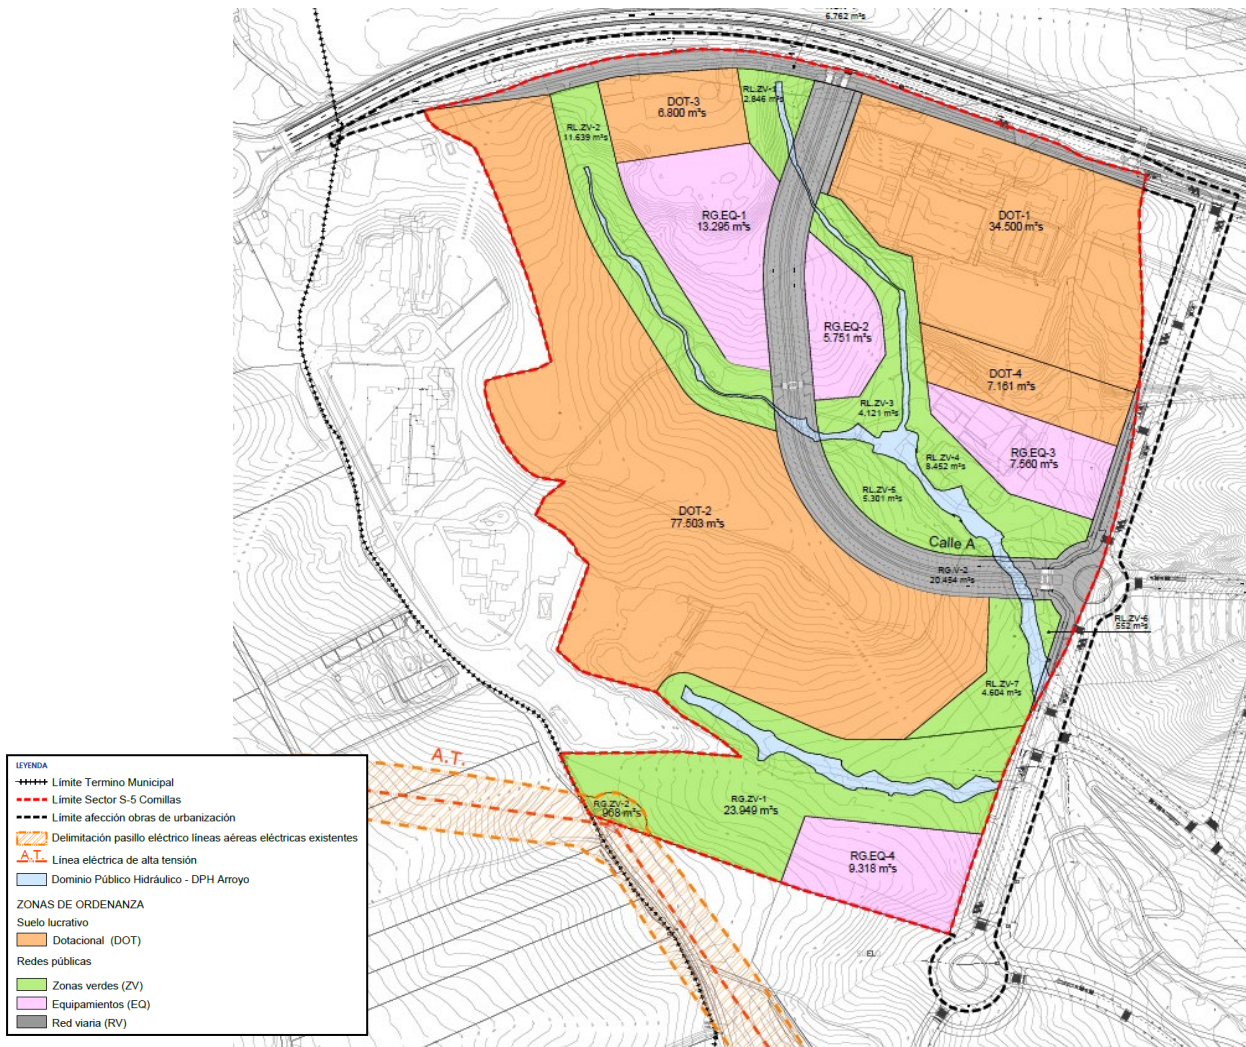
Plano P.O.1 Zonificación del presente Plan Parcial
